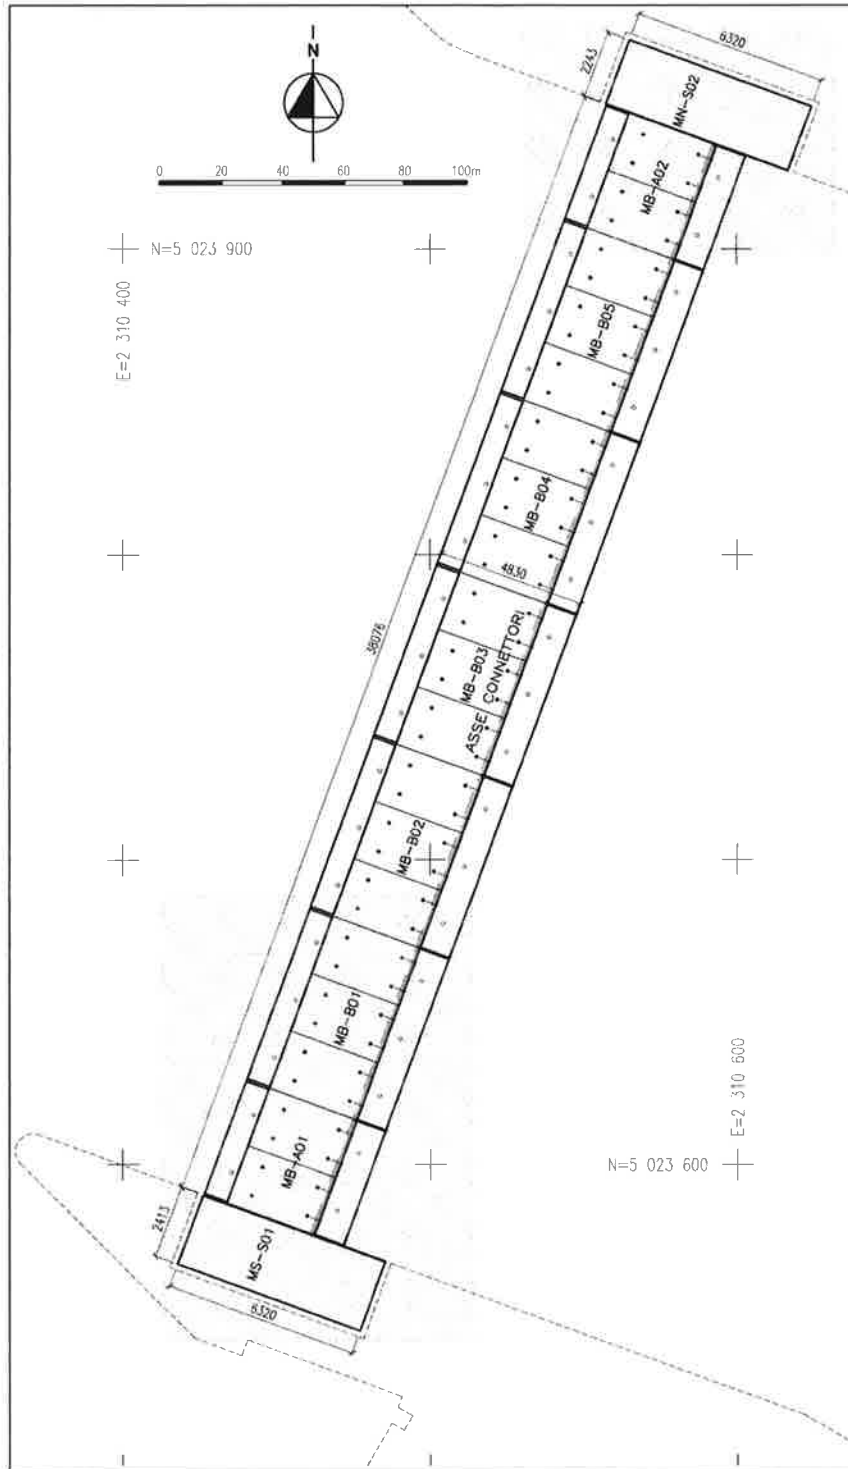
PLANIMETRIA DELLA BARRIERA DI MALAMOCCO
